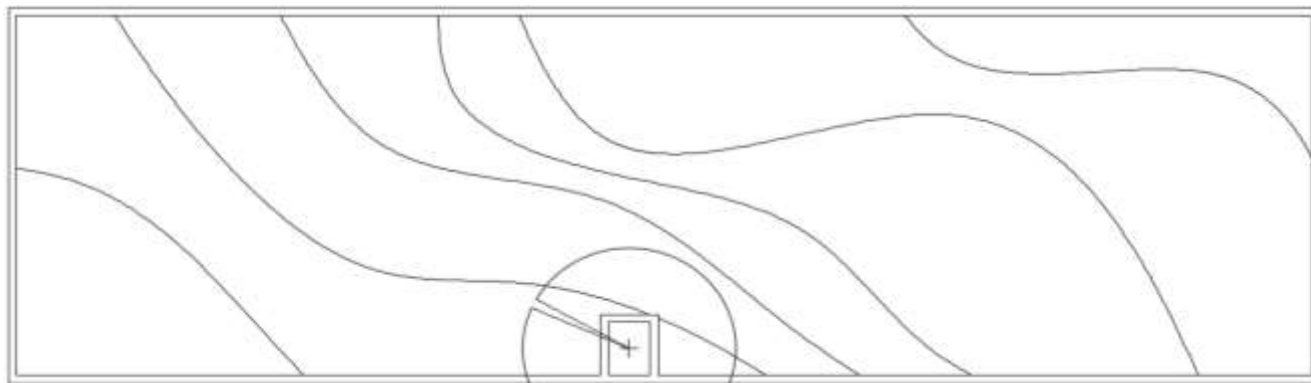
Planta arquitectónica del espejo de agua. GVHT.
